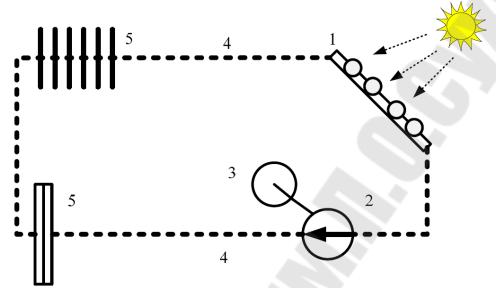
Система отопления с металлическим проточным нагревателем: 1 — металлический проточный нагреватель; 2 — насос принудительной циркуляции; 3 — автоматический регулятор; 4 — трубопровод; 5 — радиатор отопления
